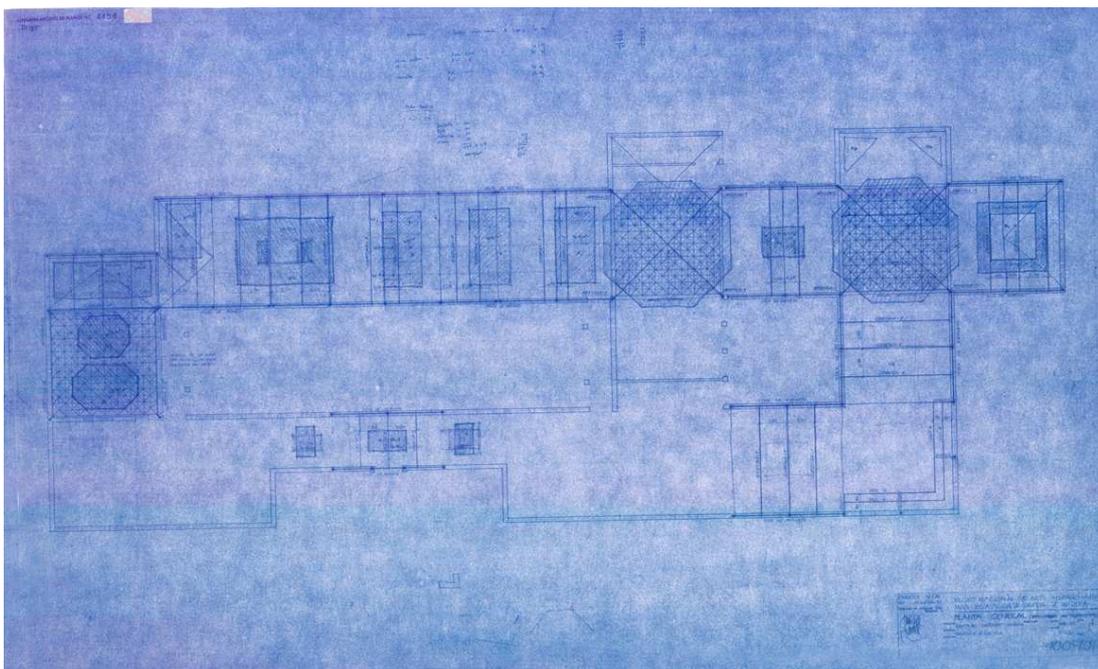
plano de instalación de cubiertas de madera realizado por Enrique Nuere Matauco. APAG / colección planos/ P. 5740.
